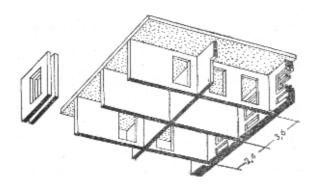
Совмещенная схема с продольными и поперечными несущими конструкциями
